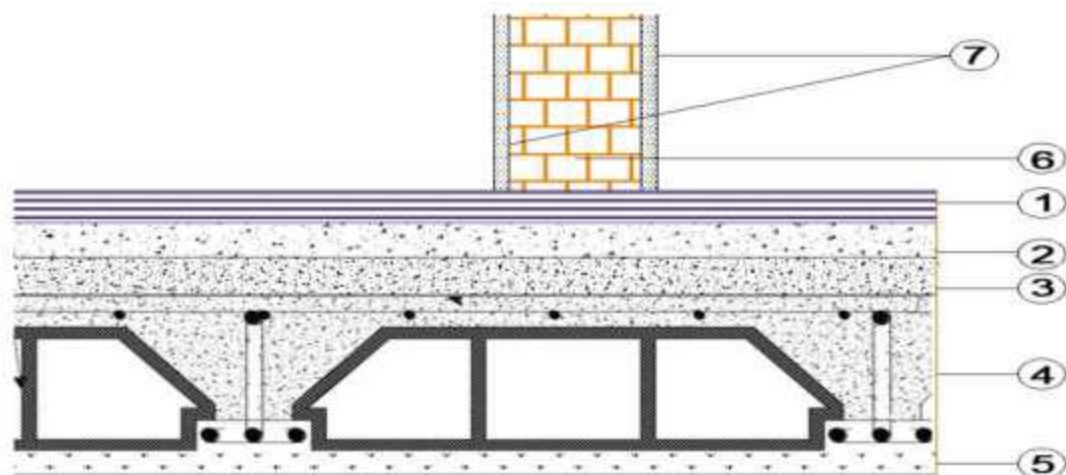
Section du plancher de l'étage actuel en matériau creux
